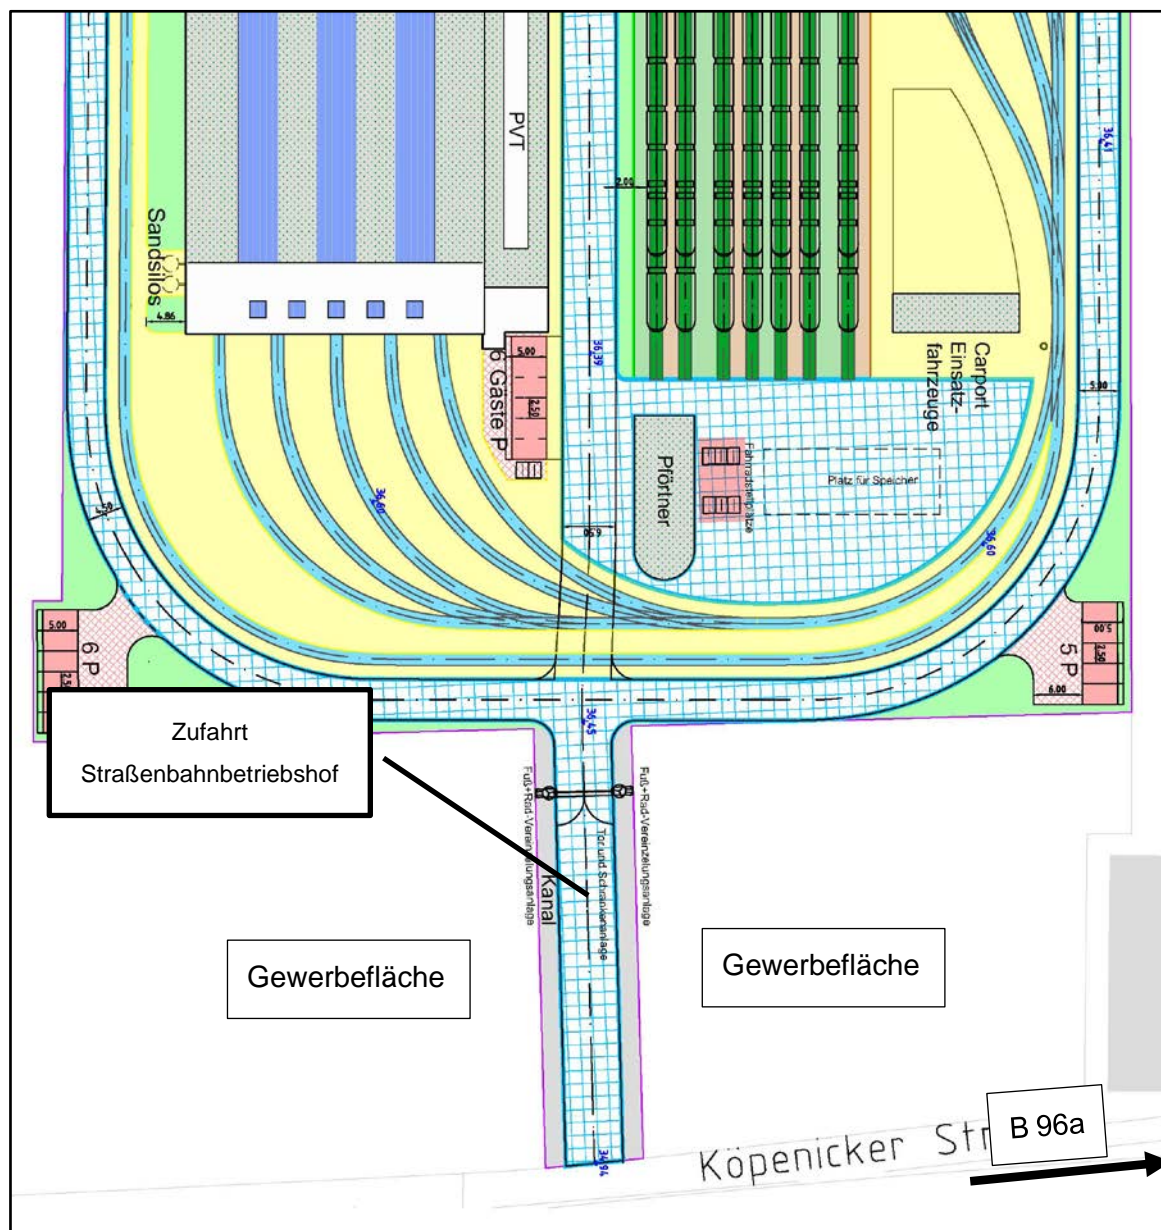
Lageplan Zufahrt Straßenbahnbetriebshof Adlershof (Quelle: BVG)
